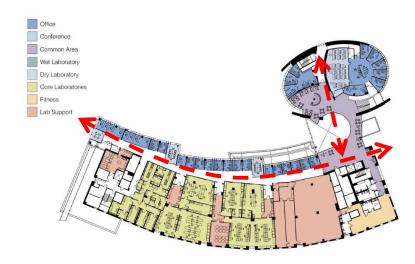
Planta arquitectónica, circulación segundo nivel.
